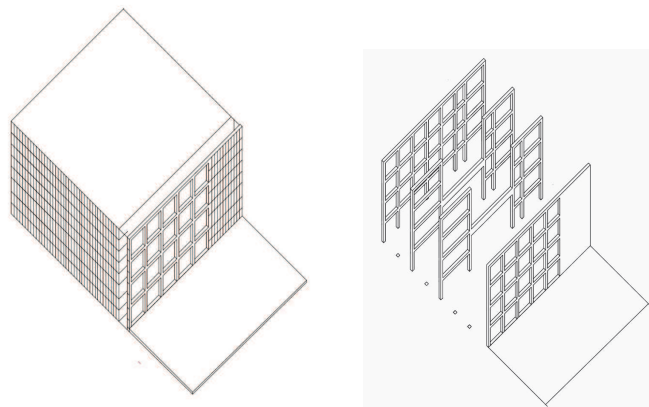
La façade principale, détachée en partie du volume, est un plan vertical dont le rabattement au sol forme le parvis. La structure de l'édifice peut se lire comme une succession de plans verticaux, une enfilade de strates qui oriente la grille d'origine.
